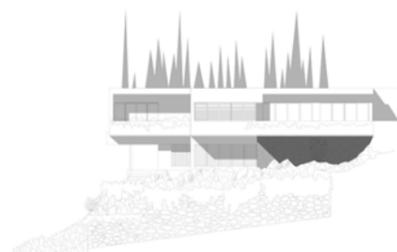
Alzado de la casa Backhaus. Redibujado a partir de alzados originales.
